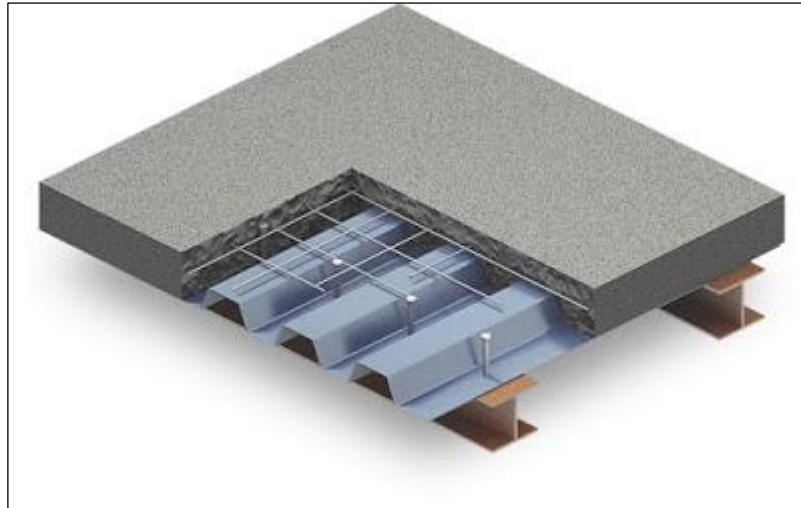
Placa Steel Deck. O PÓRTICO. Conheça o Steel Deck. [En línea] 18 de Octubre de 2015. <http://o-portico.blogspot.com/2015/10/conheca-o-steel-deck.html>
